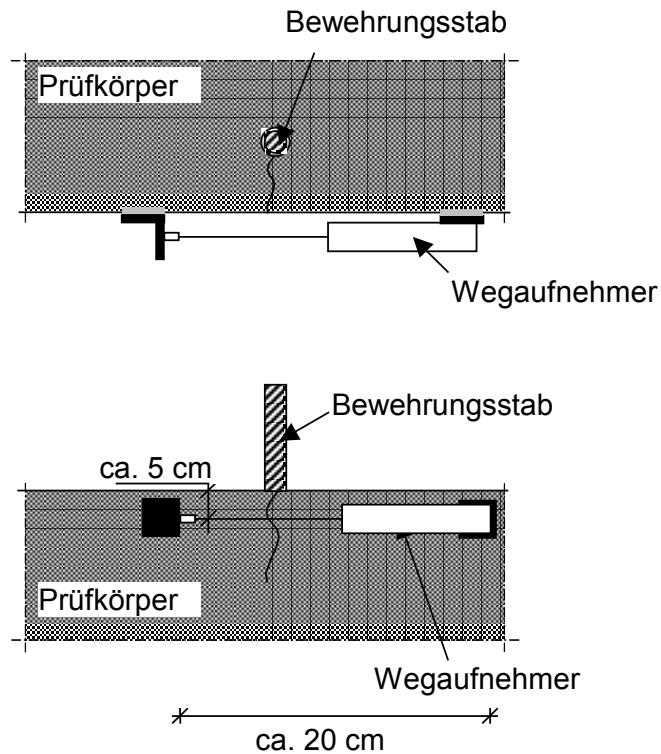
Anordnung des Wegaufnehmers an der Betonoberfläche zur Messung der Öffnung des Spaltrisses
